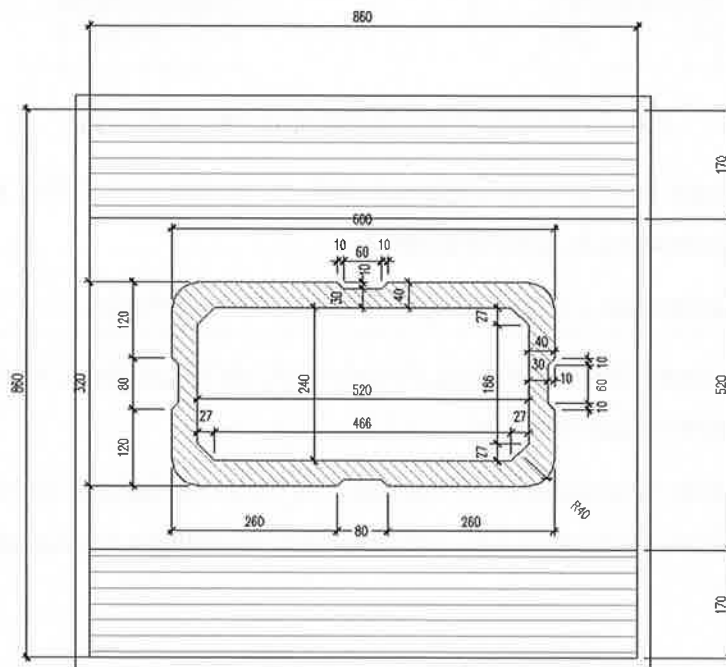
Pianta fondazioni ed elevazione pila tipo Bauladu VI01
